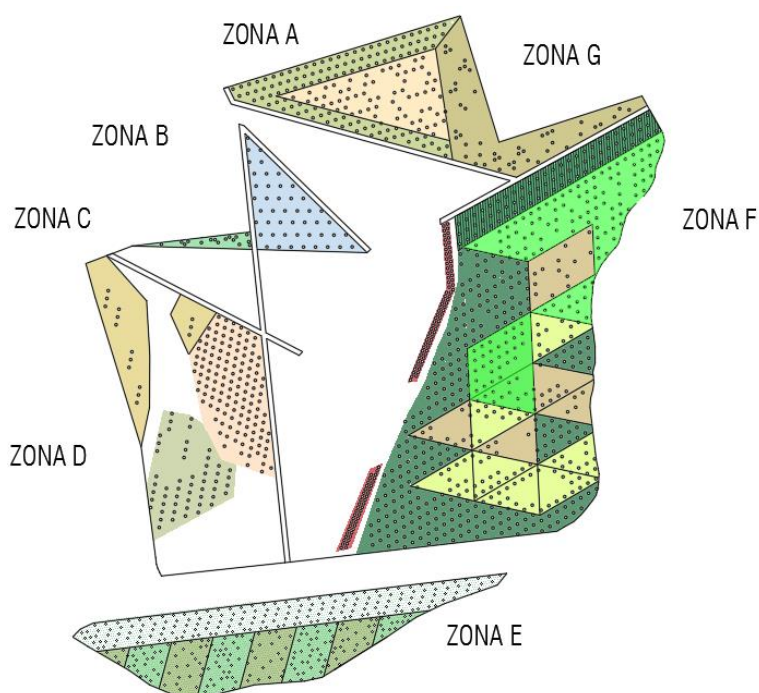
PLANOL DE PLANTACIÓ I DISTRIBUCIÓ DE L'ARBRAT FONT: PRÒPIA
